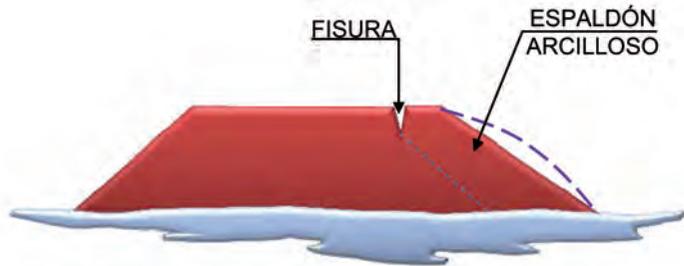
Fisuración por cambio de volumen en espaldón
